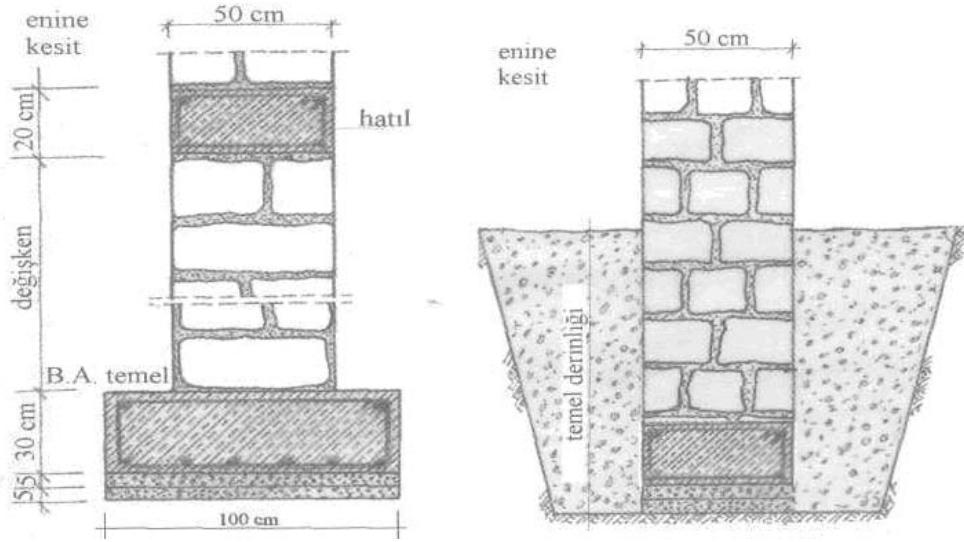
Beton ve B.A. ile yapılan duvar altı temel
